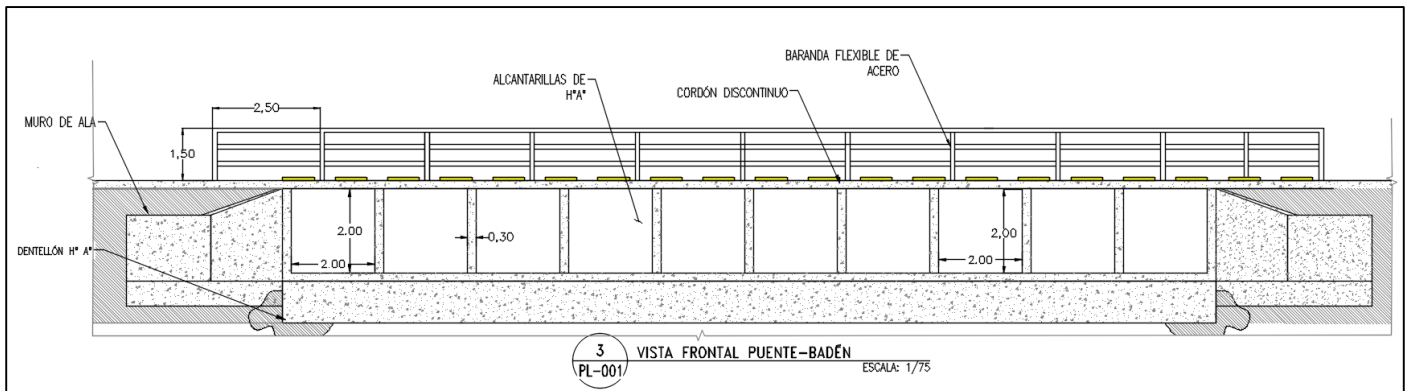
Sección transversal alcantarillas, (sin escalas)
